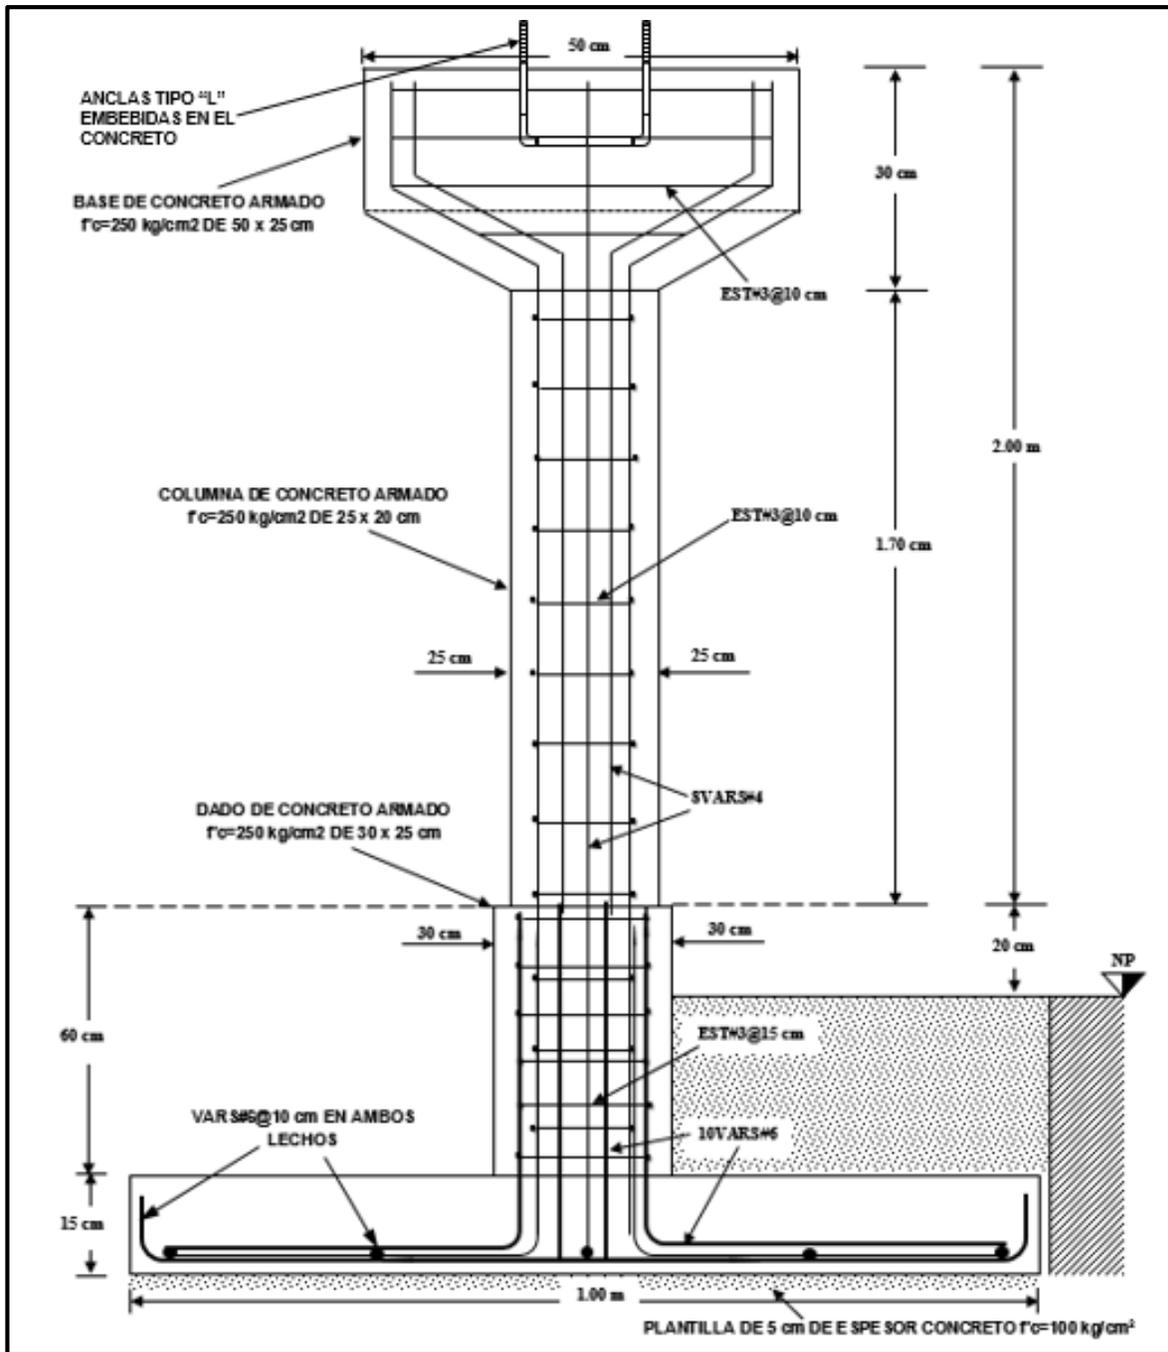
Armado de zapata aislada, dado, columna y base para Equipo Menor
